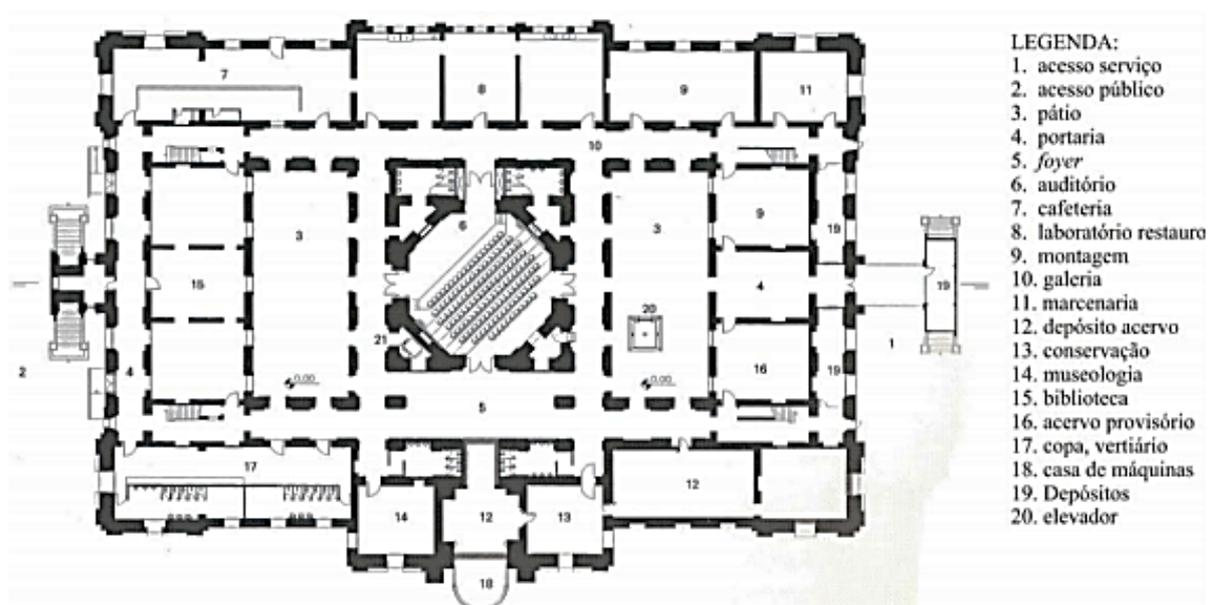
Planta do pavimento térreo da Pinacoteca.
